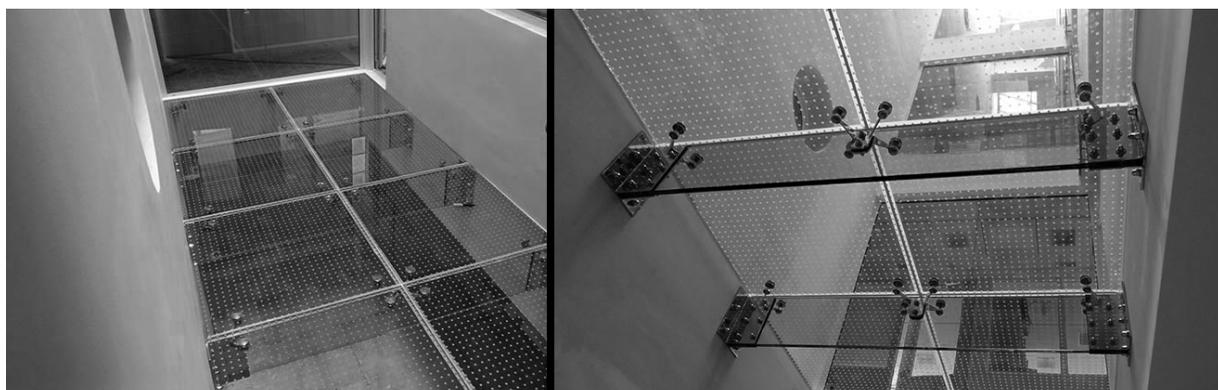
Перекрытие коридора по стеклянным балкам GLASSCON GmbH
